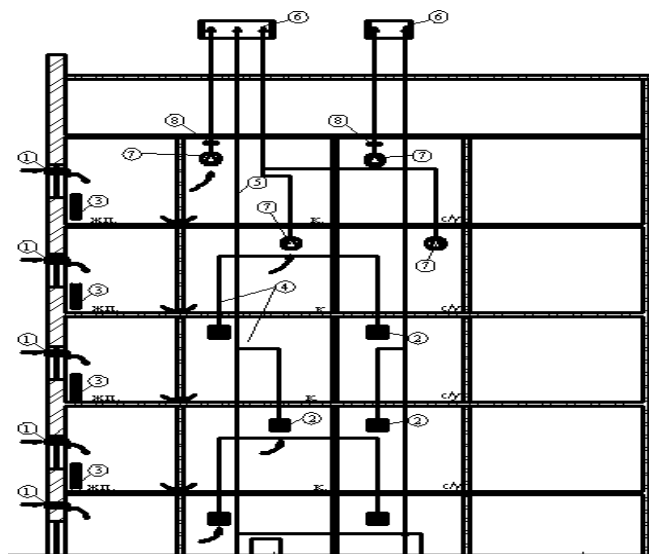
Схема системы естественной вентиляции с отдельными сборными вытяжным каналами/
